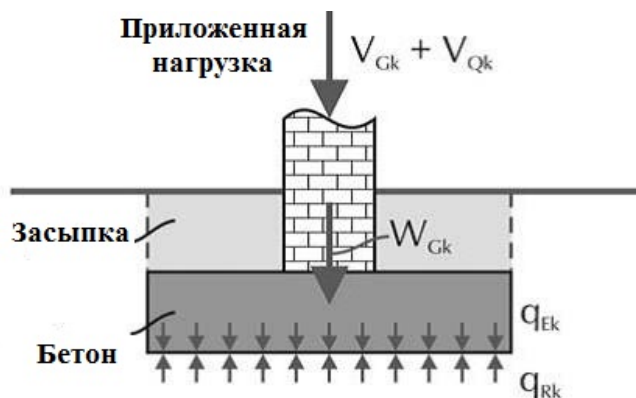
Вертикальные воздействия на ленточный фундамент [6]
